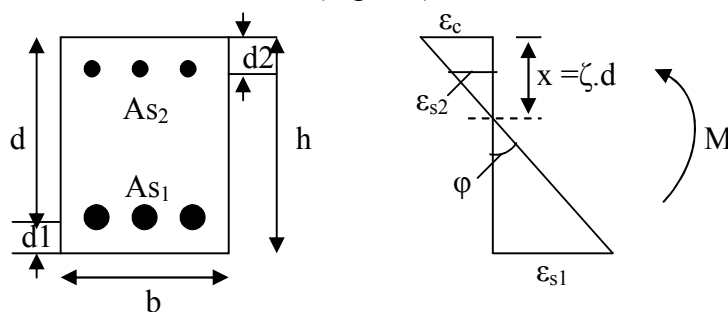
Courbure d'une section de poutre rectangulaire [23]
